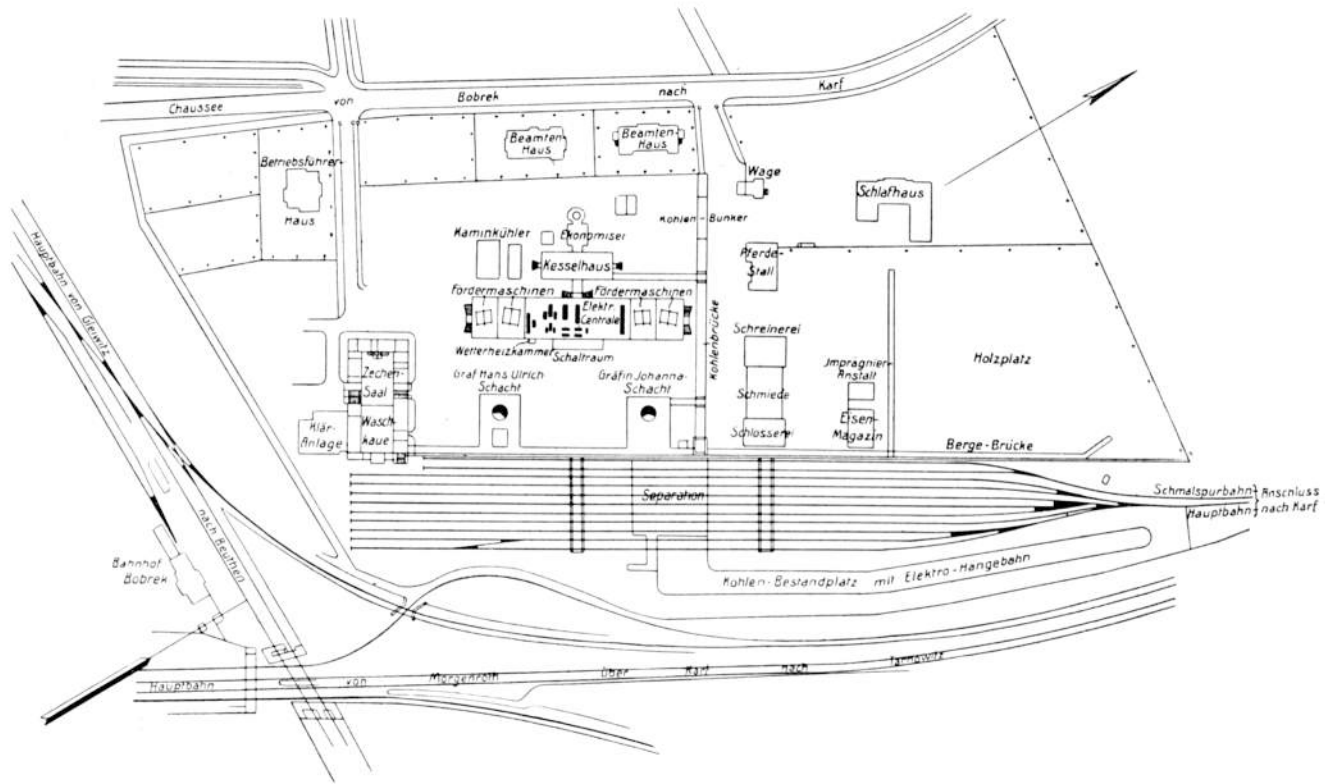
Lageplan der Gräfin Johanna-Schachtanlage.
